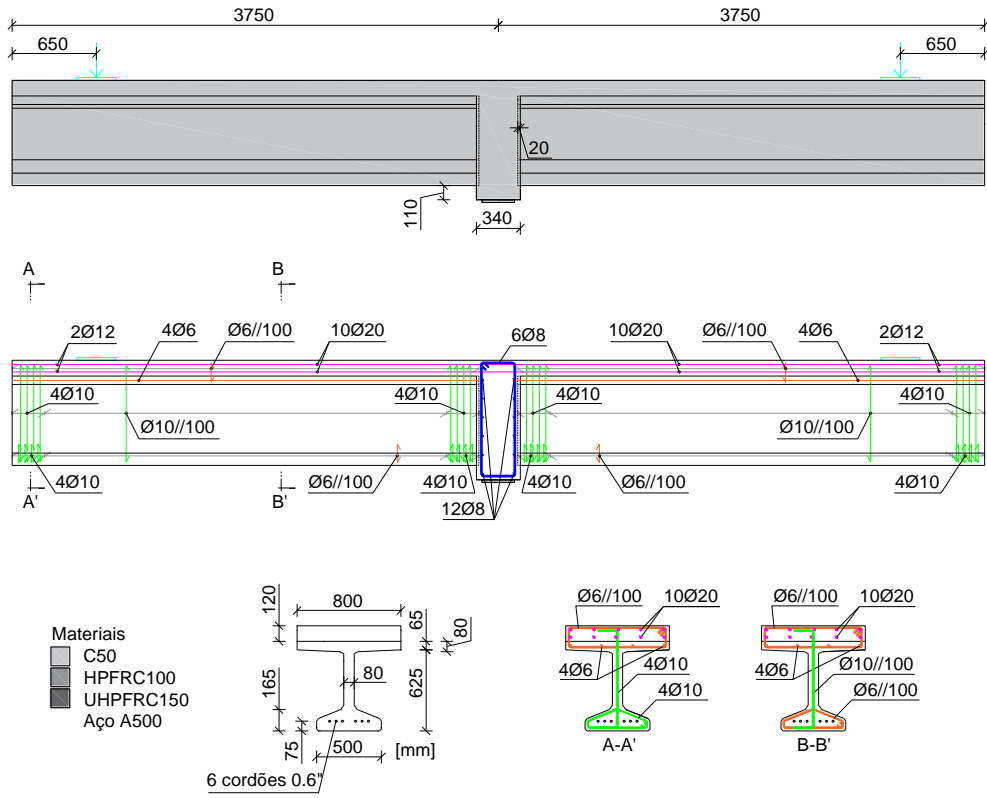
Modelo V1 – Vigas e laje em betão convencional C50.
